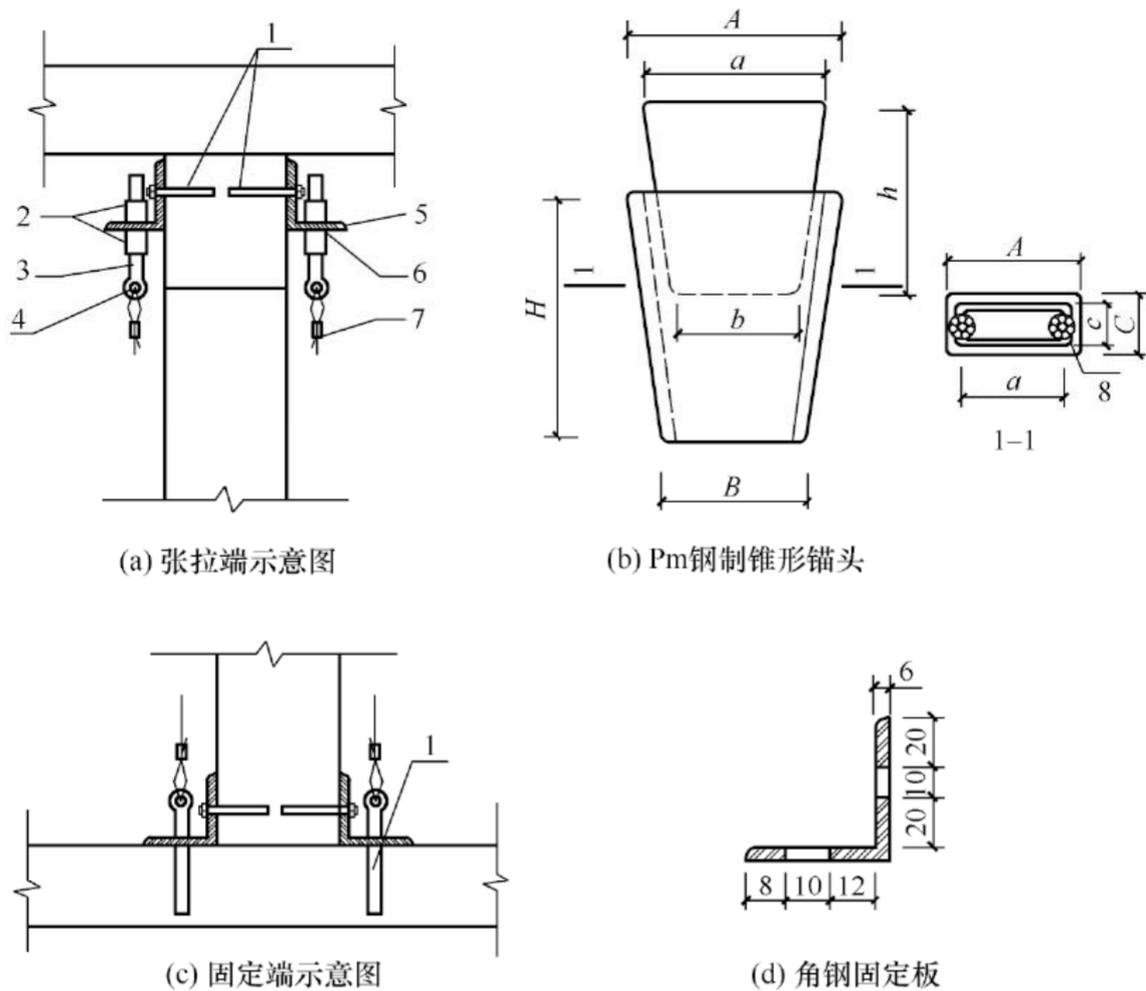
采用锥形锚头紧固钢丝绳的端部锚固构造
